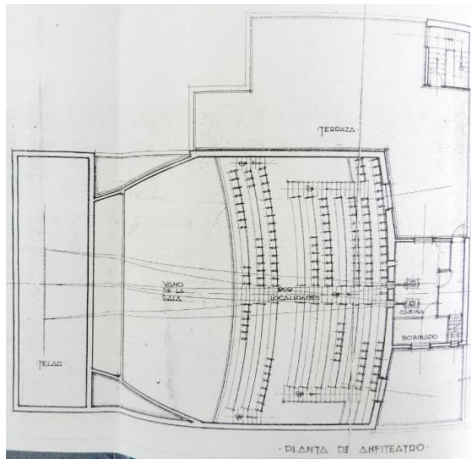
Plano planta de anfiteatro e intermedia (MORCILLO VILLAR, L., 1953).
